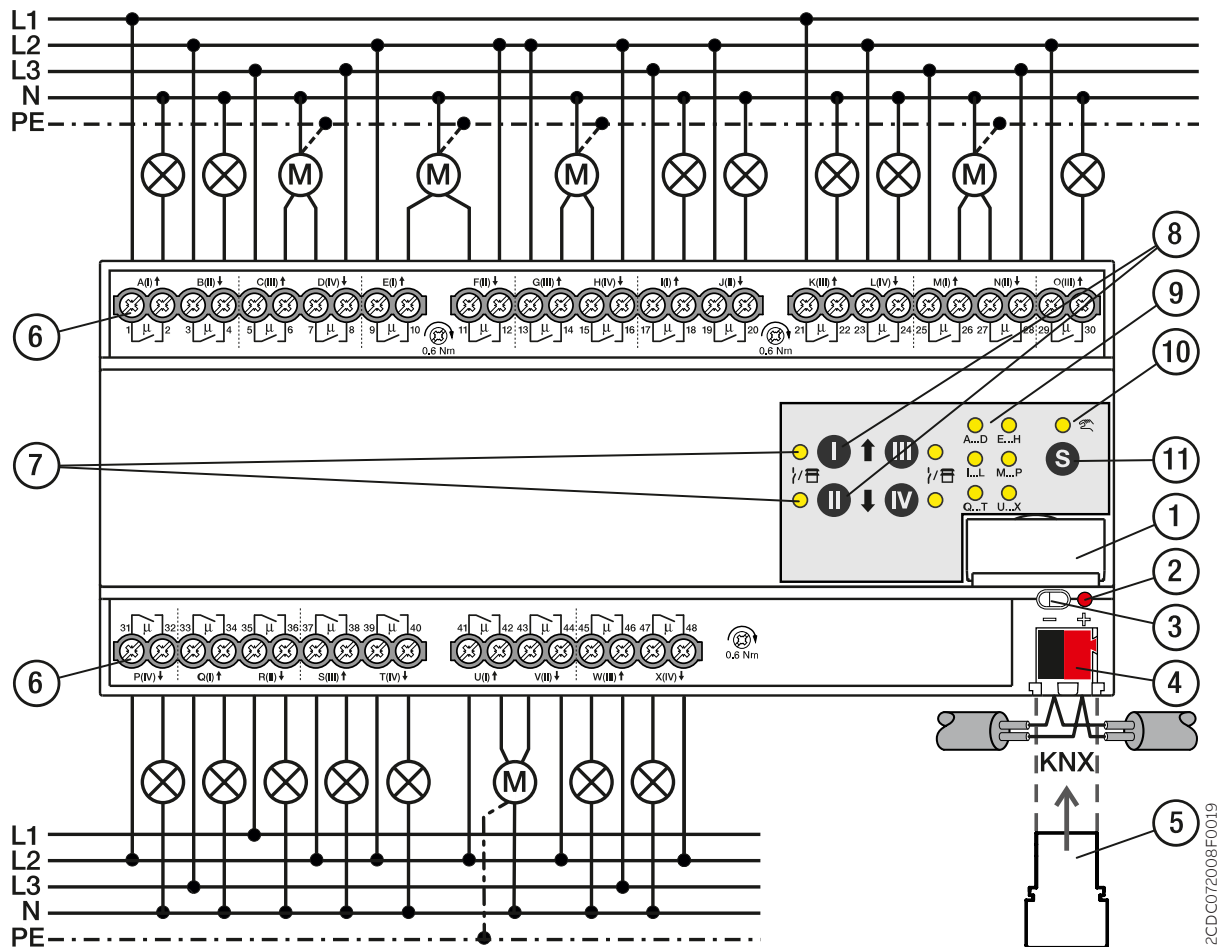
Schema di collegamento SAH/S 24.x.7.1
